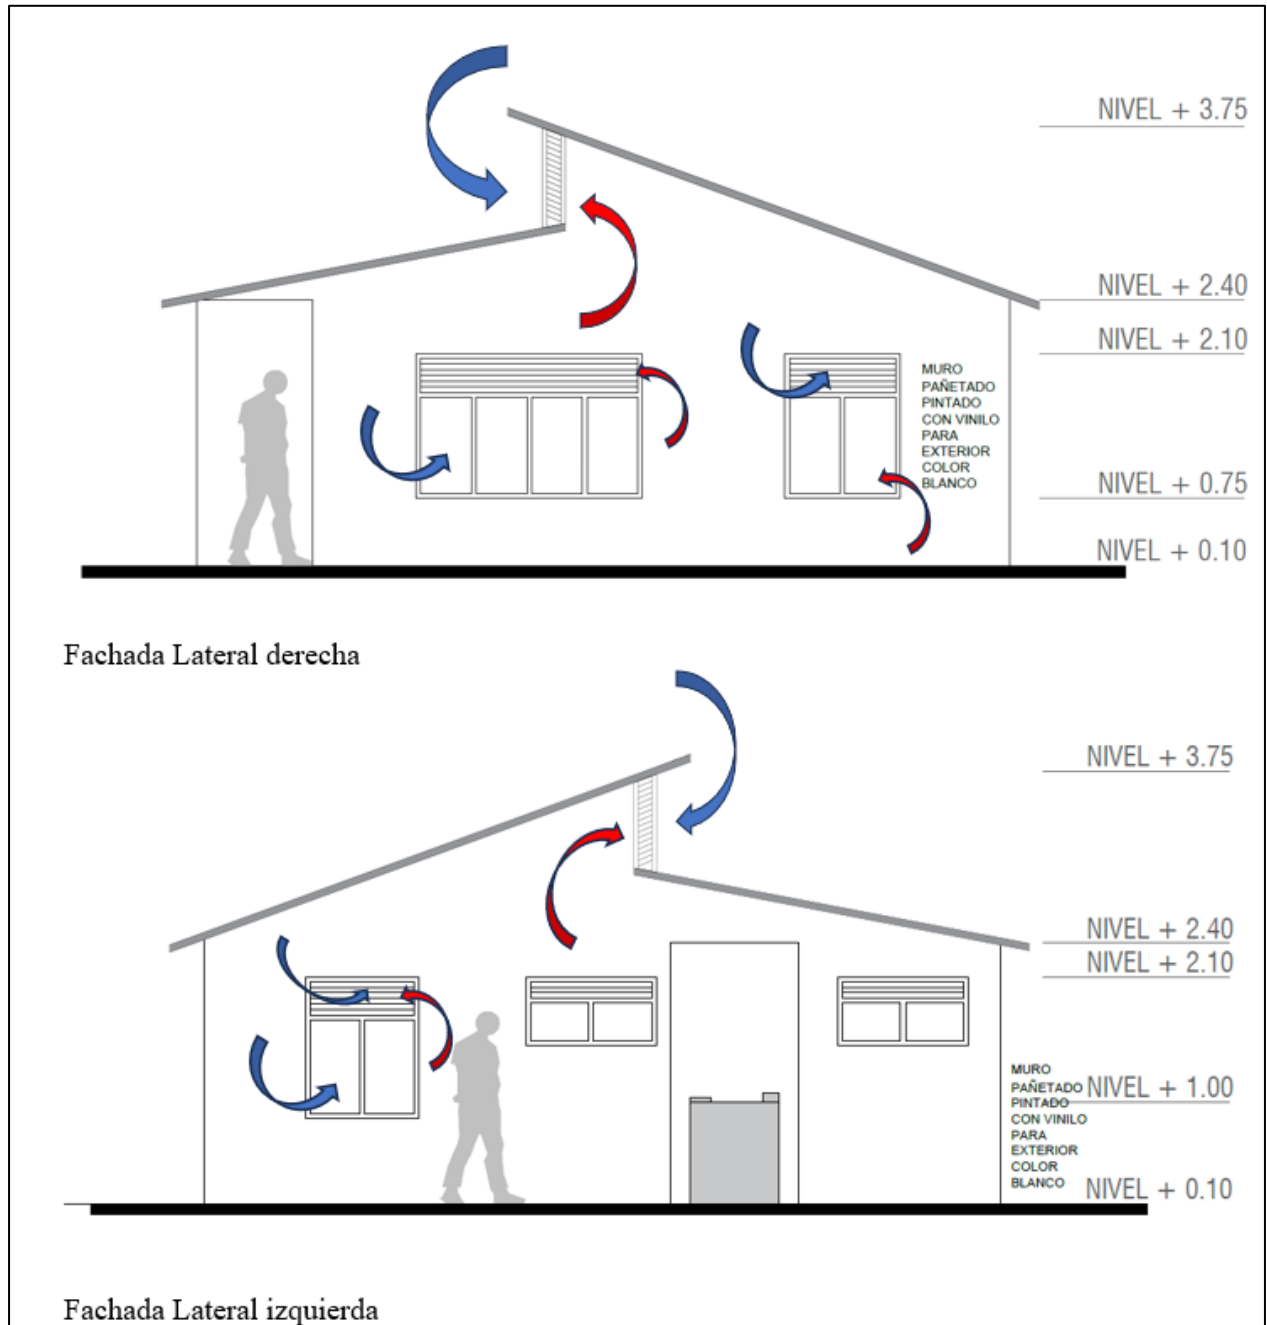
Confort bioclimático a través de la lucerna. Fuente: Autores, 2024.
